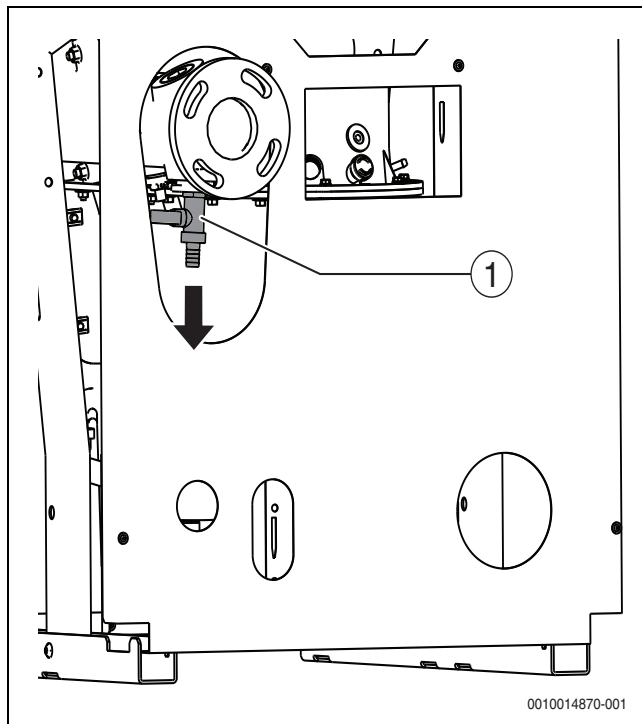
Desmontagem da torneira de drenagem (representado: caldeira com ligação do flange, versão à direita)
